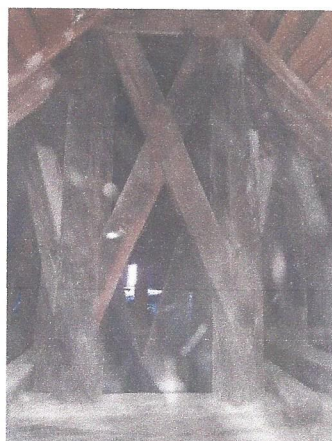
Słup drewnianej konstrukcji dachu.
